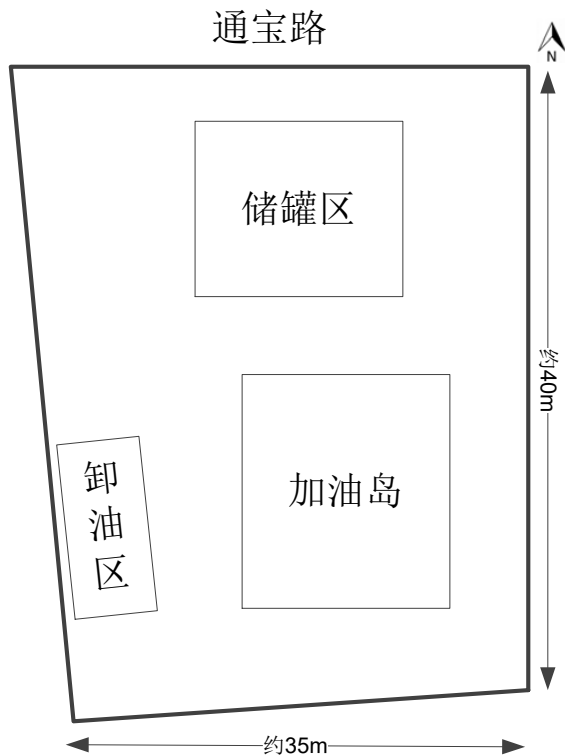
义乌市廿三里供销社加油站平面布置图
